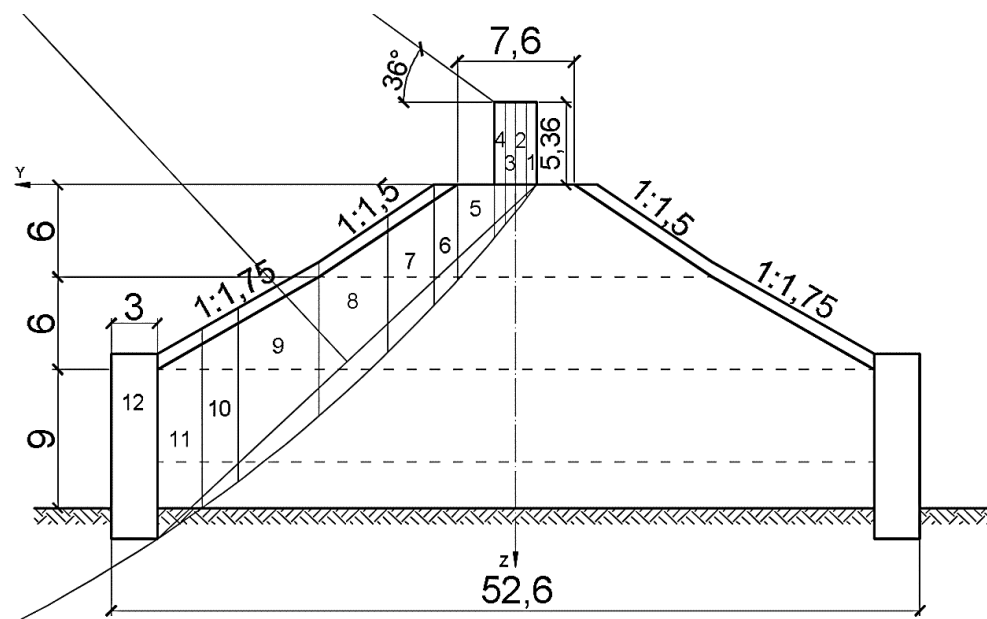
Конструкция насыпи, усиленная габионными подпорными стенками, расчетная схема поверхности разрушения по низу стенки
